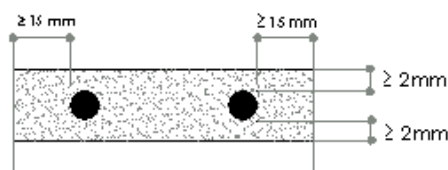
Recobrimento das armaduras em junta de assentamento
